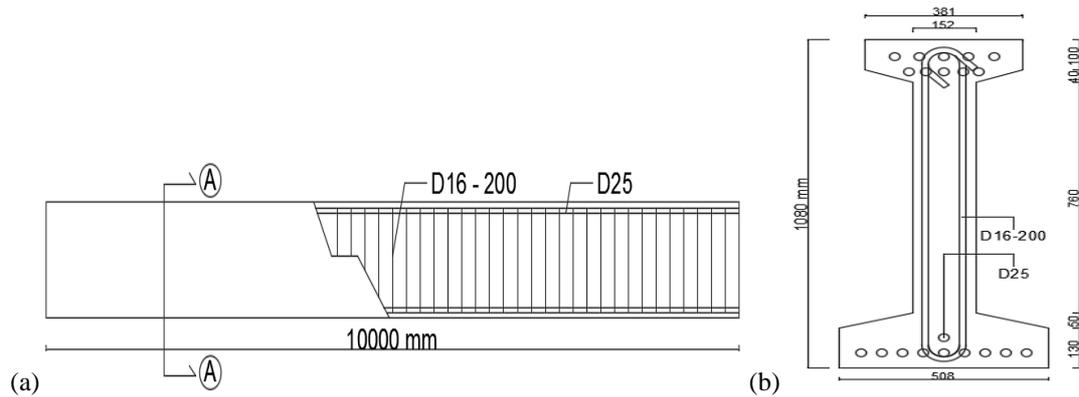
(a) Penampang memanjang; (b) Potongan A-A balok BU3
